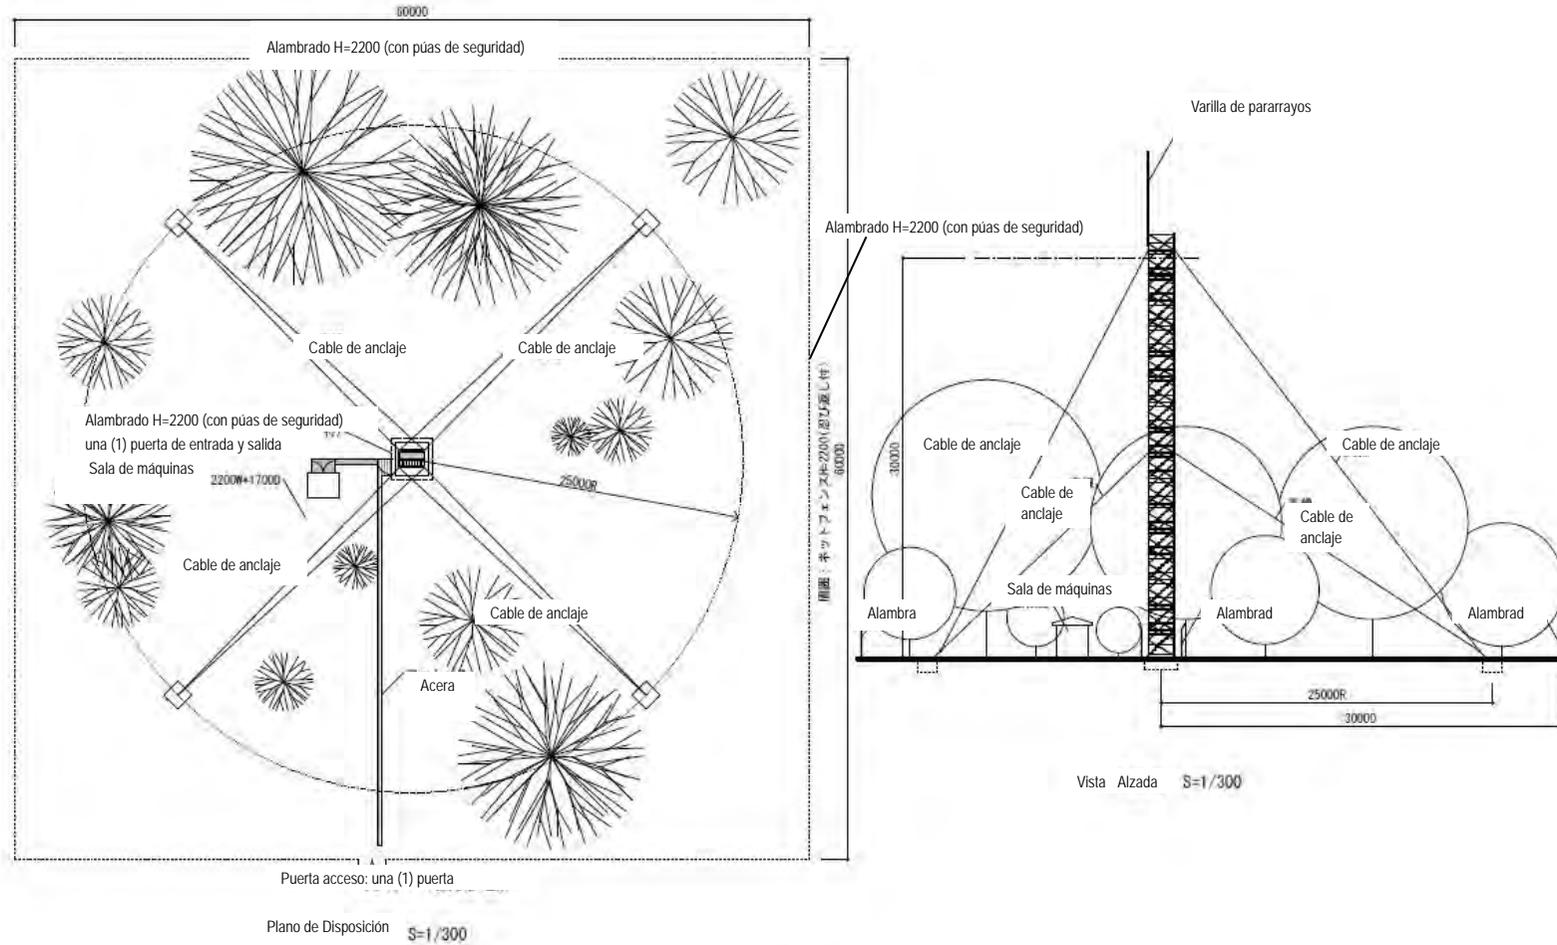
Plano de Disposición y Vista Alzada de la Torre (h=30m) (plano referencial)
